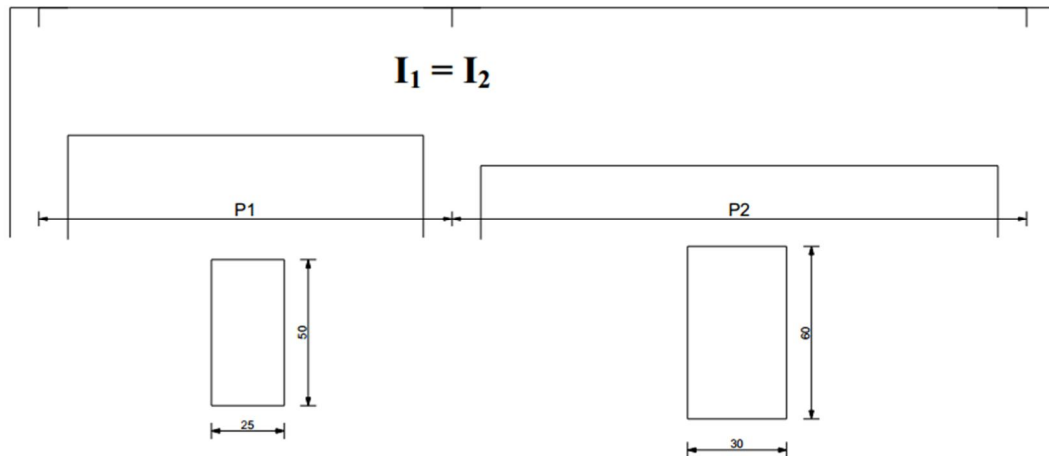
schéma des poutres sur la file Y10-PH-R+1
